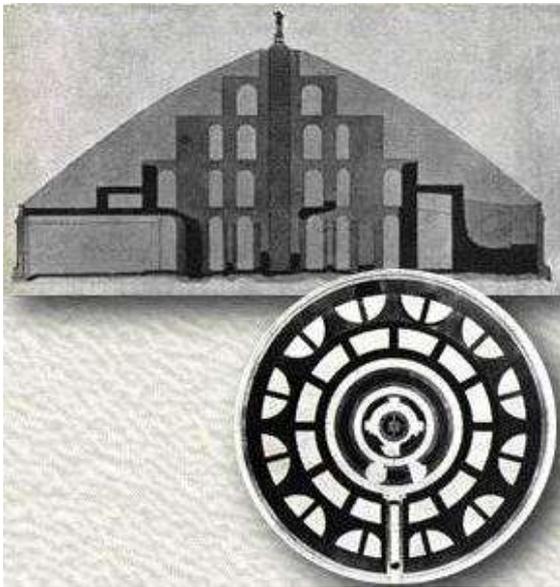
Planta y alzado del mausoleo de Augusto.
